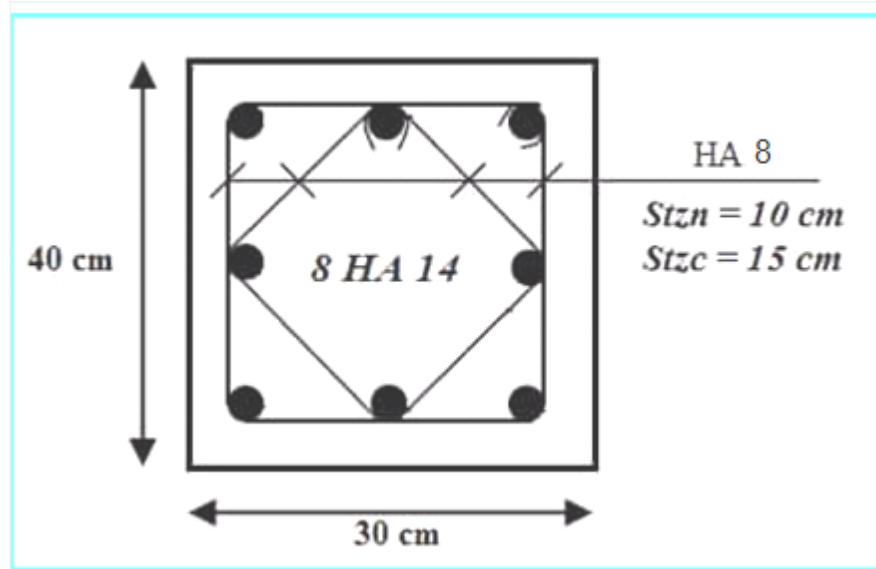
Schéma de ferrailage de poteau 30×40.
